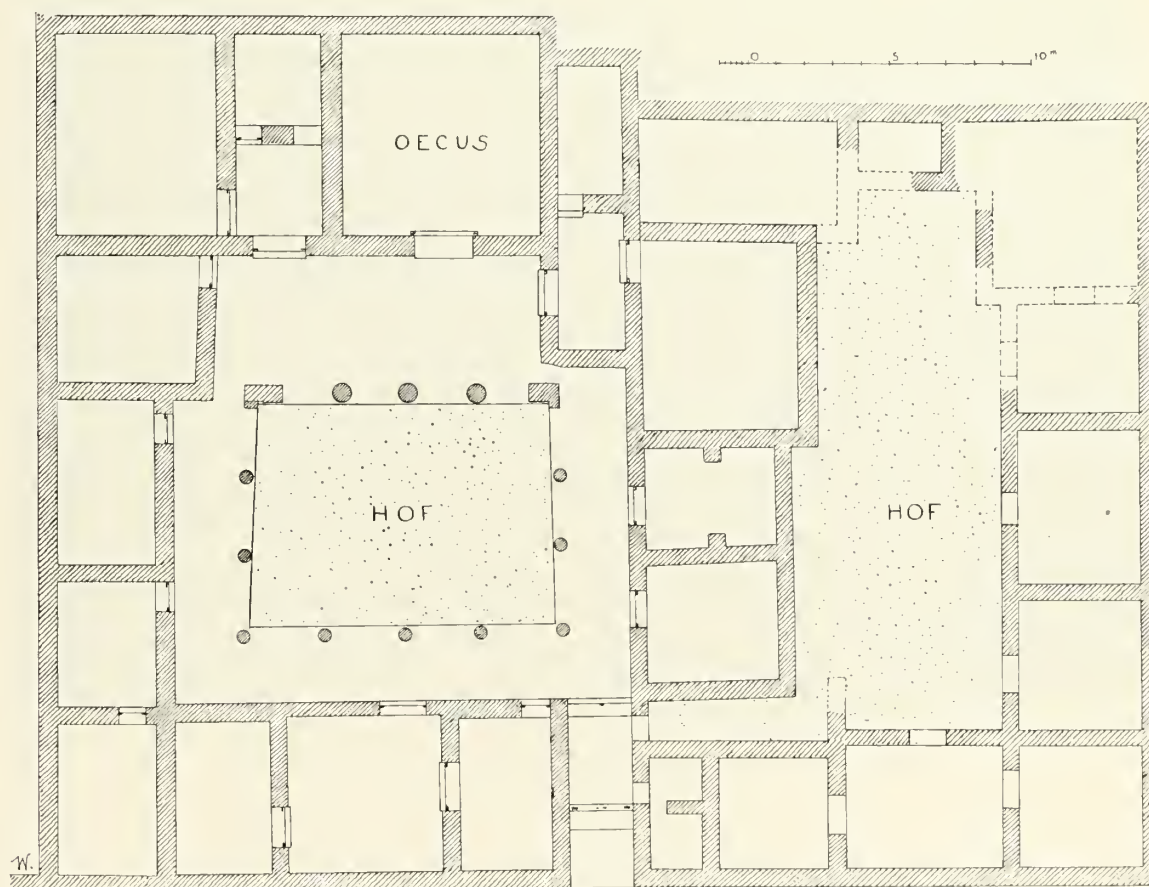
Grundriss des Hauses Nr. XXXIII und des anstossenden Hauses nach dem Umbau.
